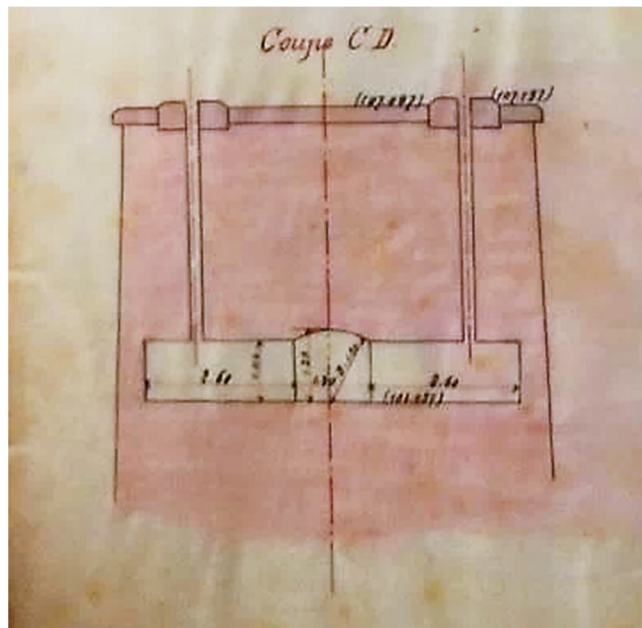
Pormenor de amarração do pilar metálico [4]
